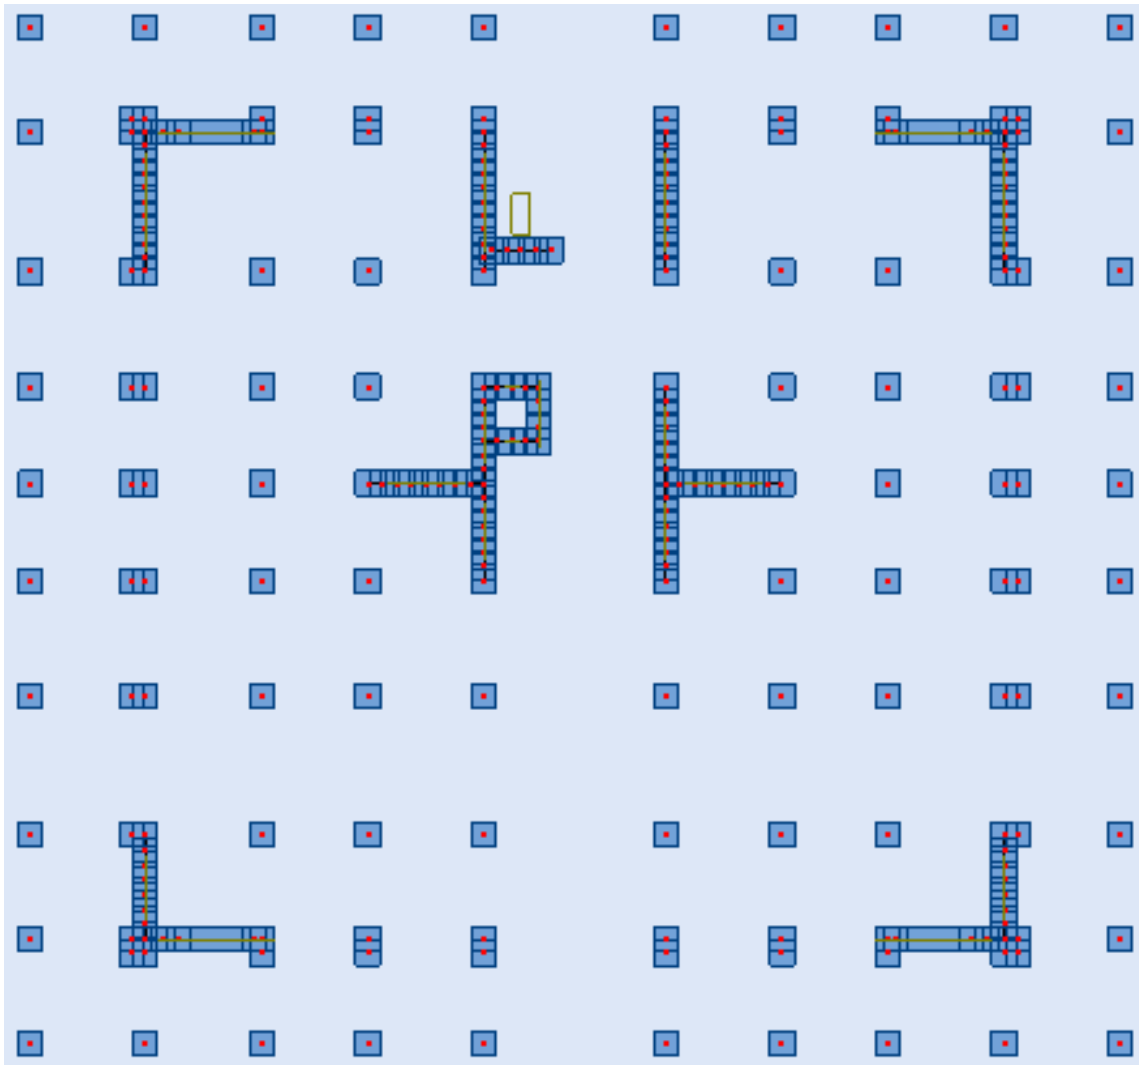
La 4<sup>ème</sup> disposition des murs voiles (voile20) et poteaux.
